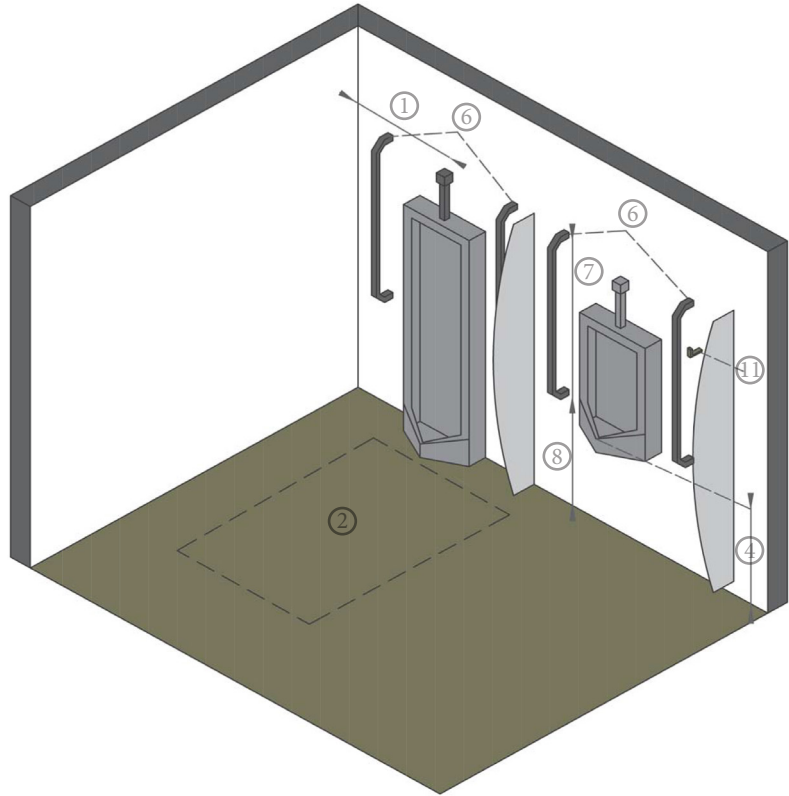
1 Altura y barras de apoyo de mingitorio
